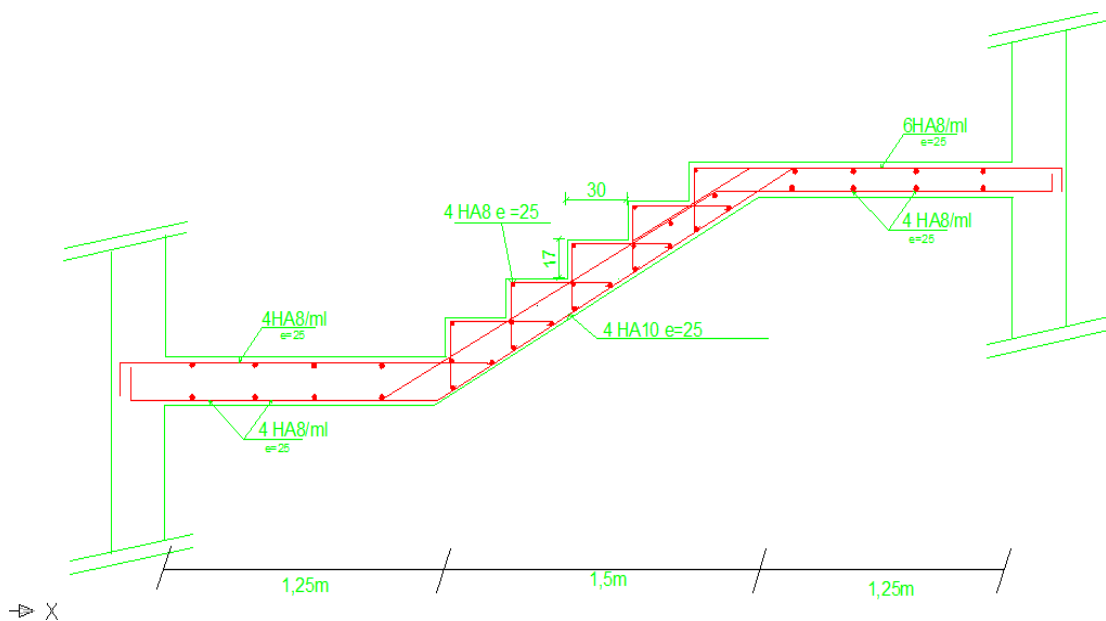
Plan de ferrailage escalier 1^{er} volée de RDC
